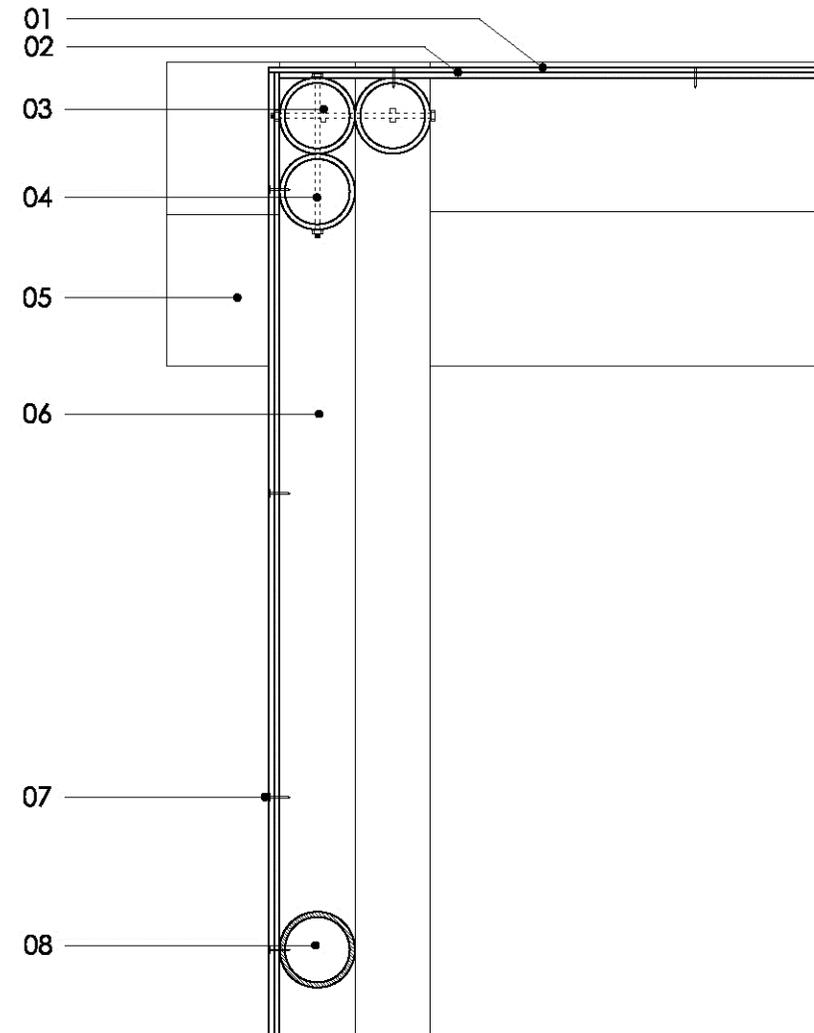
Instalación de diagonales en muros estructurales sobre base flotante.
